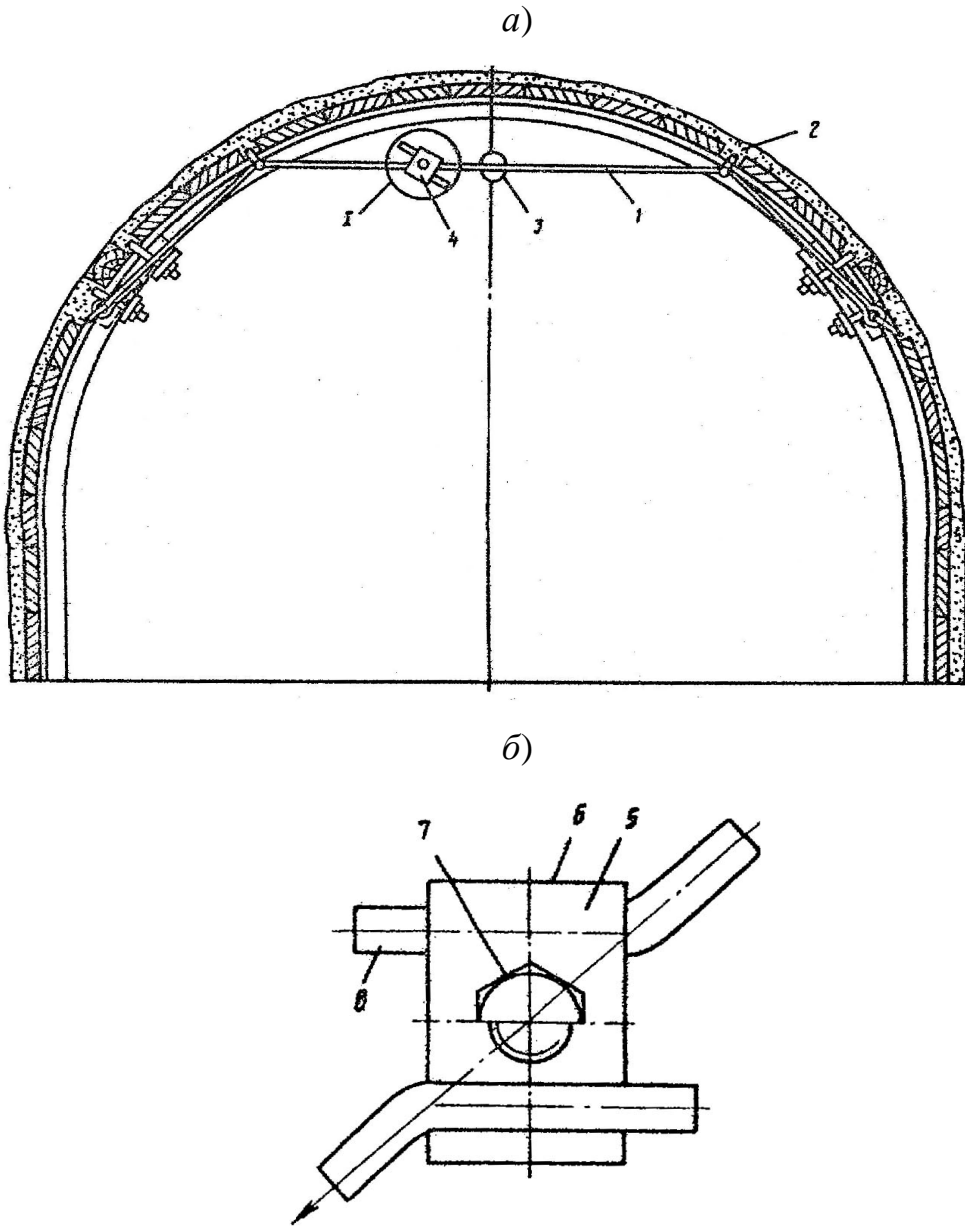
Металеve аpочне кpиплення зi стяжкой: а – загальний вид кpиплення; б – конструкція податливого вузла
